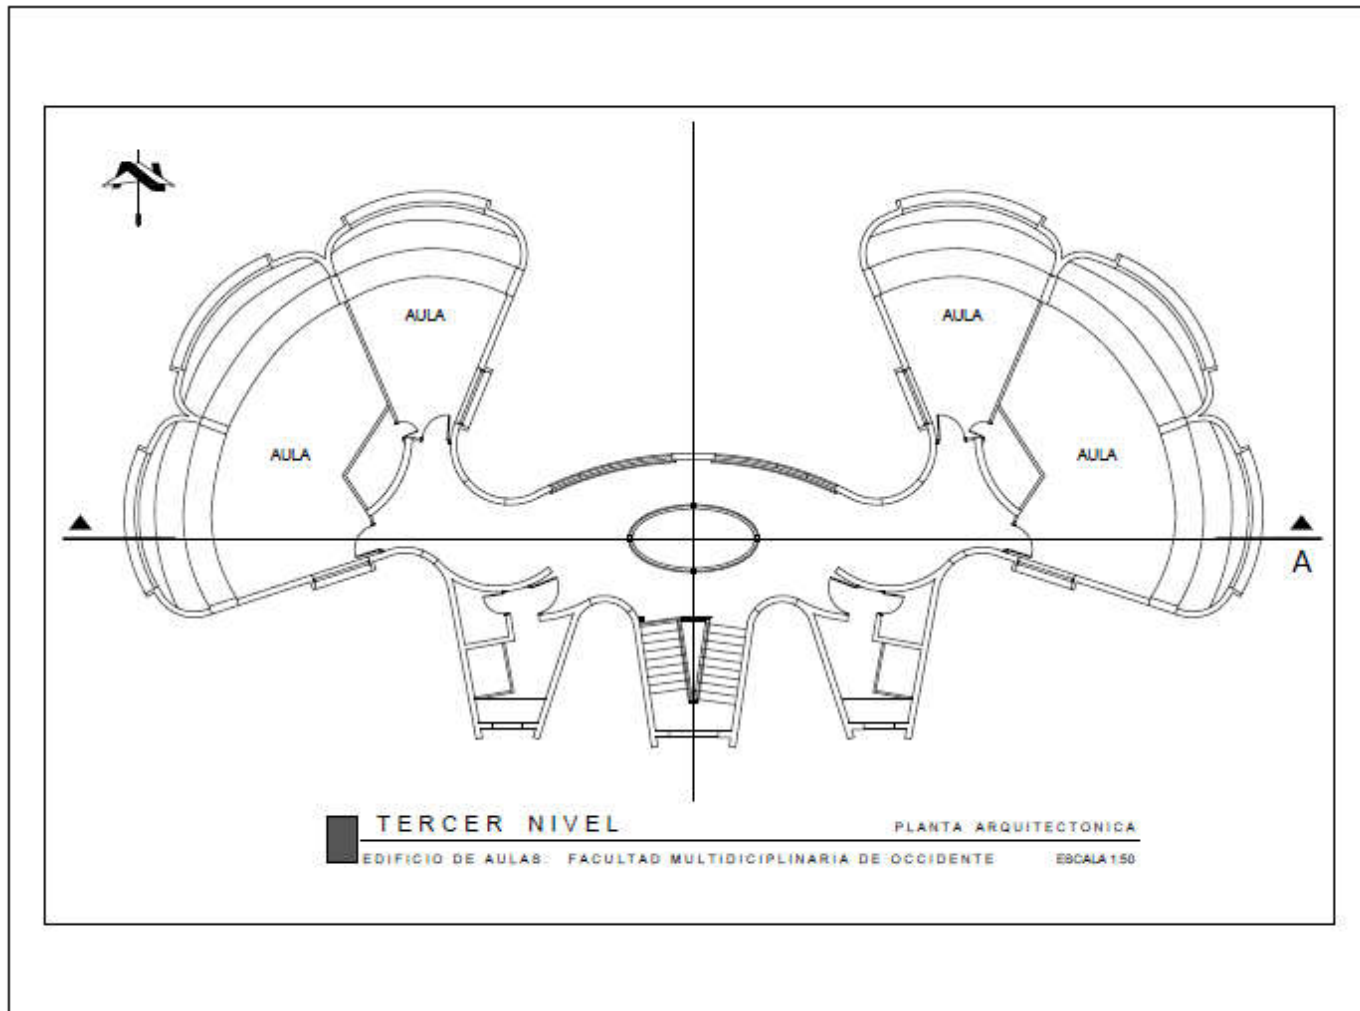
Planta arquitectónica del tercer nivel del Edificio Bunker
